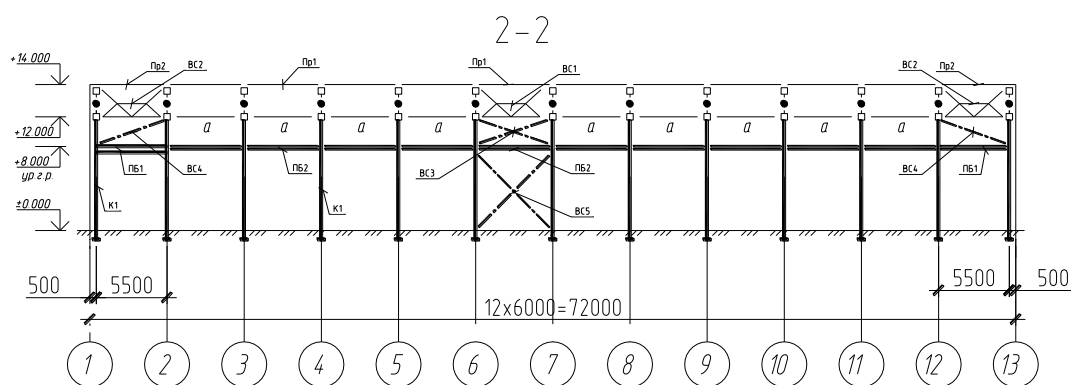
Продольный разрез 2-2 здания в пропорльной части пролета
